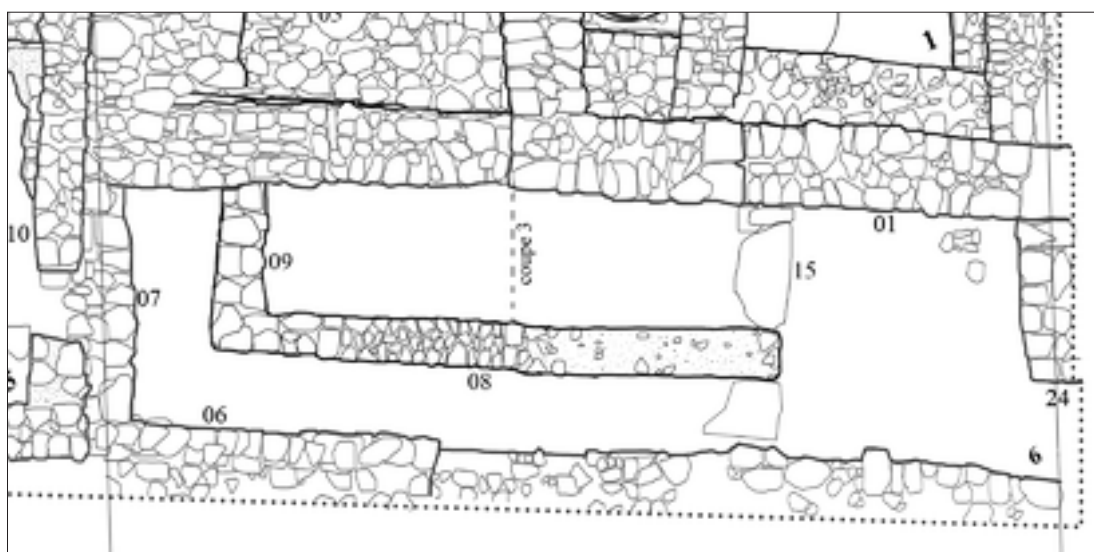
Zone 5, plan du secteur 6 (Jean-François Pichonneau).
